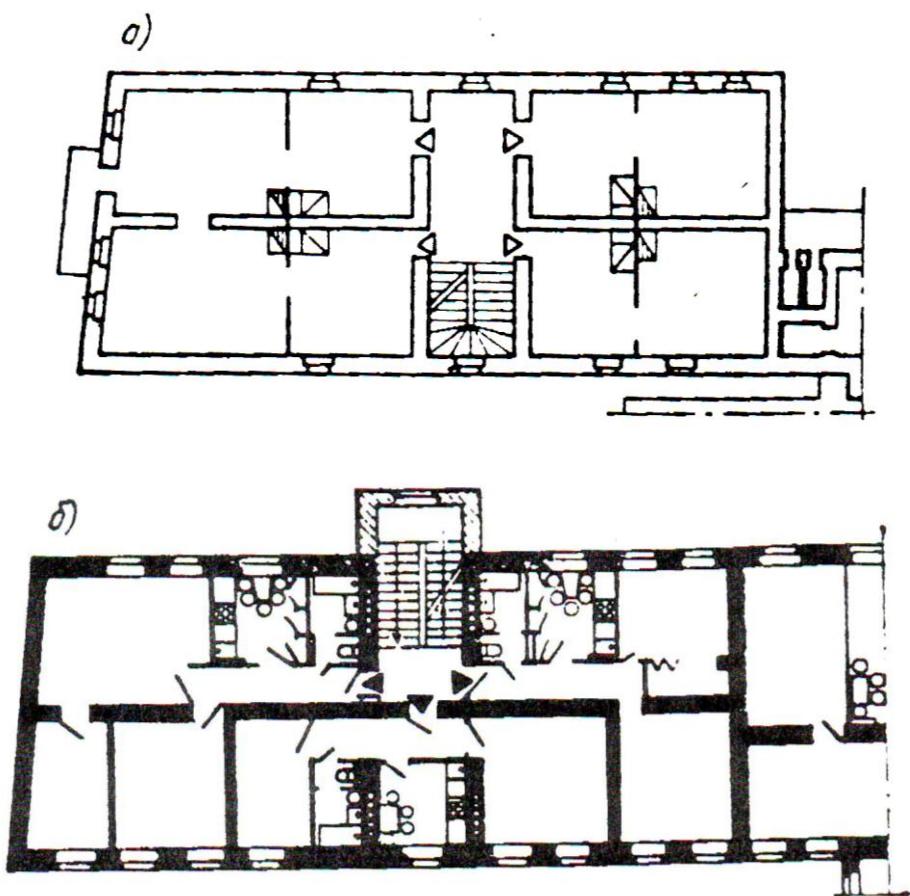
Частичное размещение лестничных клеток за пределами здания: А – до реконструкции; б – после реконструкции
